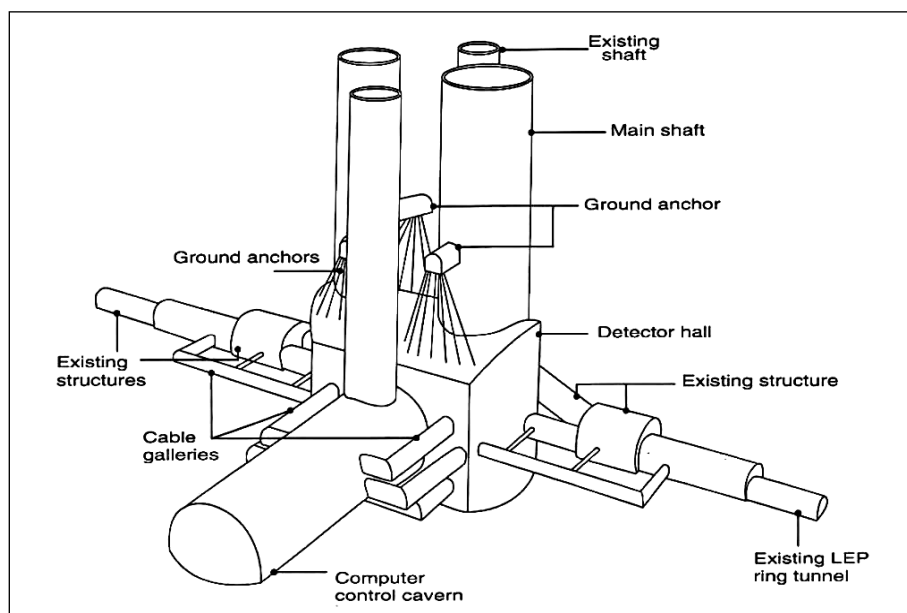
Подвеска кровли детекторной полости на канатных анкерах.
